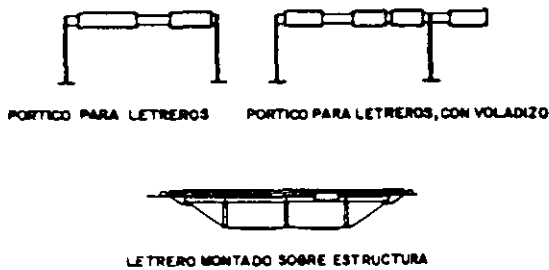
Estructuras típicas para sostener indicadores elevados, según las normas de AASHO.
